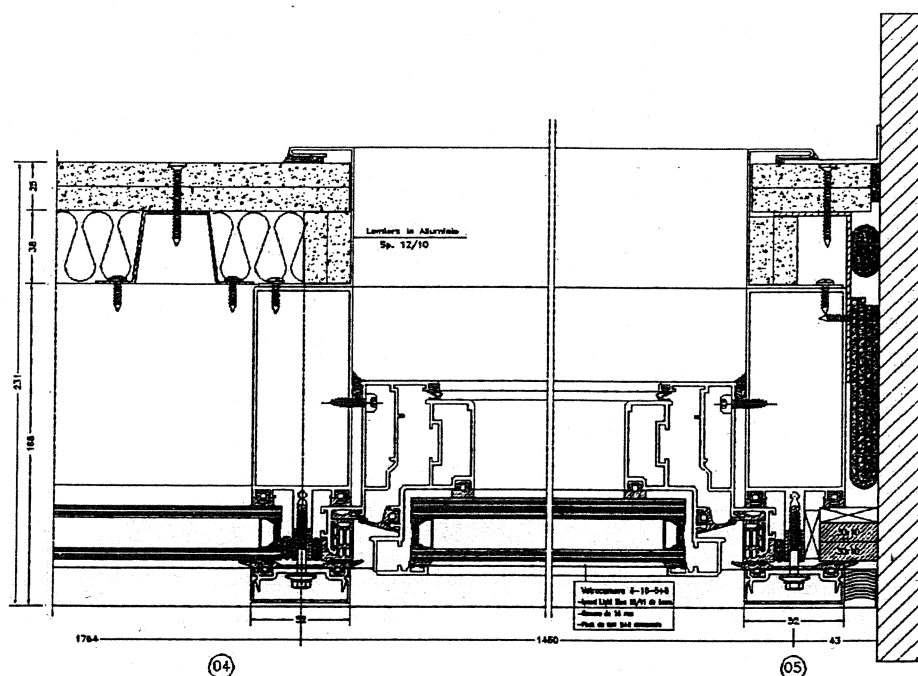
Schema dell'elemento sottoposto a prova. Sezione orizzontale 4-5.
